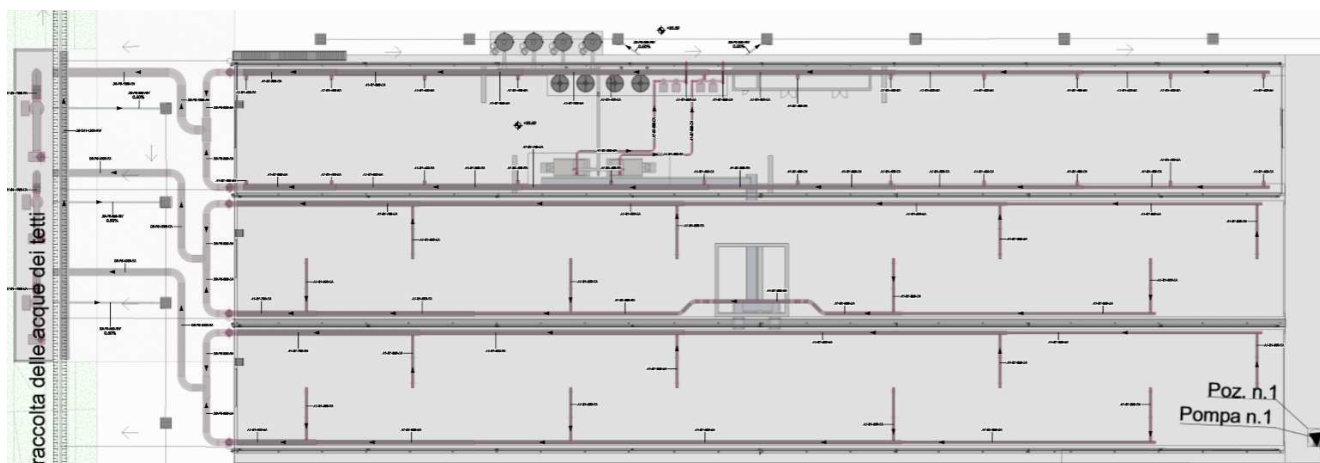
Schema planimetrico per la rappresentazione delle zone d'impianto la cui deodorizzazione viene gestita separatamente
